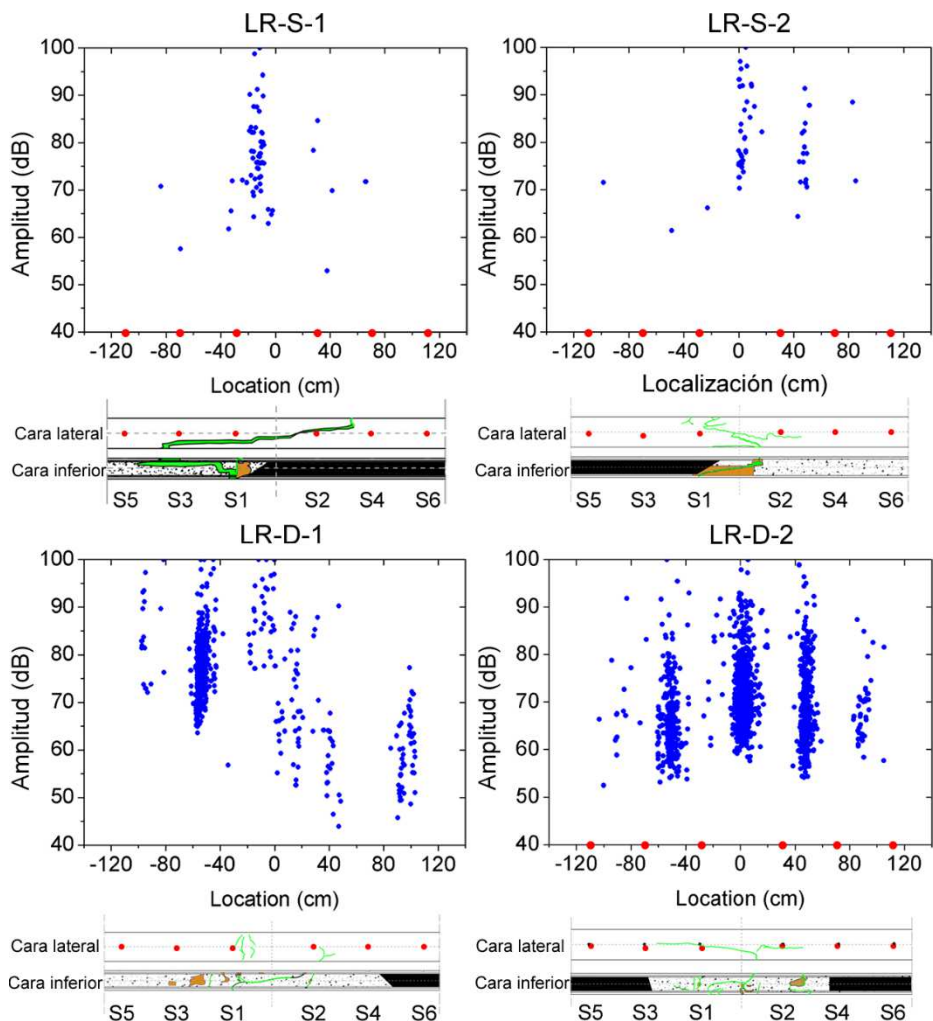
Hits localizados durante los ensayos a flexión del Grupo 2 para las vigas con refuerzo longitudinal (LR). Puntos rojos: Posición de los sensores de EA. Línea verde: Grietas de la madera al final del ensayo. Zona naranja: Rotura de la interfase madera-resina. Zona punteada: Deslaminación CFRP-madera. Zona negra: Laminado de CFRP.
